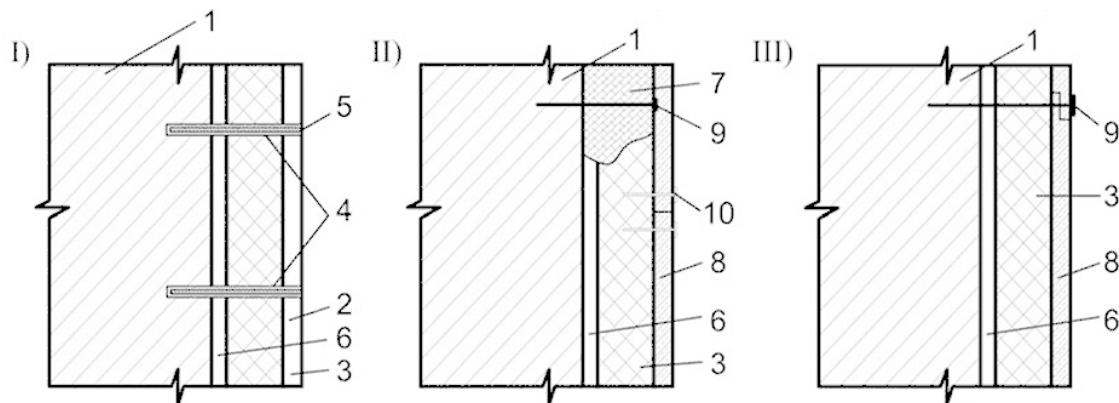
Три варианта конструкций утепления наружных стен крупнопанельных зданий: 1 – существующая стена; 2 – базальтофибробетонная стяжка; 3 – утеплитель; 4 – шпонки из базальтофибробетона; 5 – анкер из полимерной арматуры; 6 – клеевой слой; 7 – деревянная рейка; 8 – волокнисто-цементные плиты; 9 – металлический анкер; 10 – шуруп-саморез
